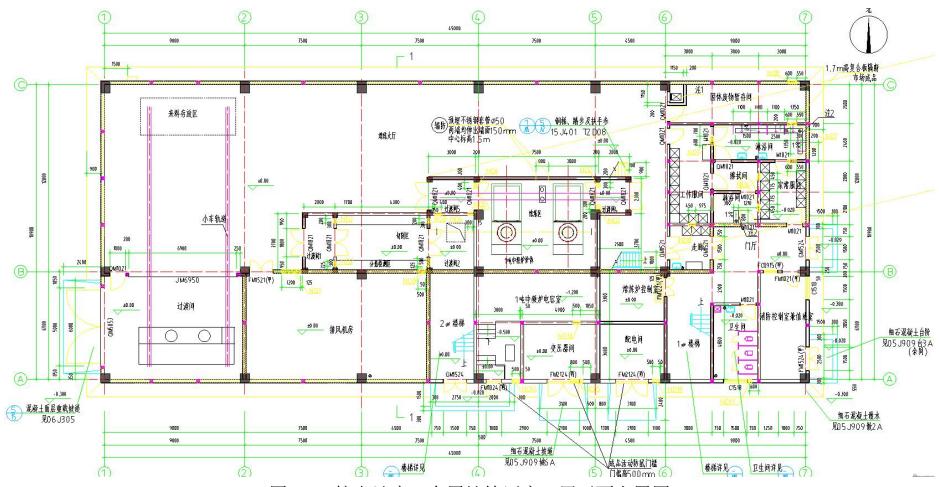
核电站废旧金属熔炼厂房一层平面布置图
